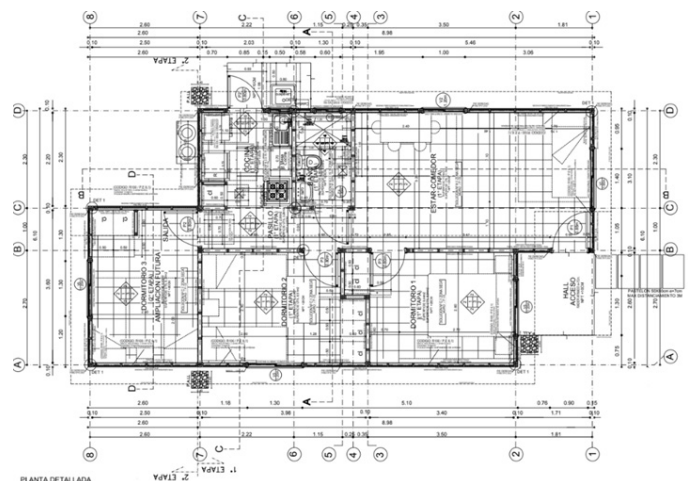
Planta arquitectura, tipología masiva. Fuente: Elaboración de los autores
